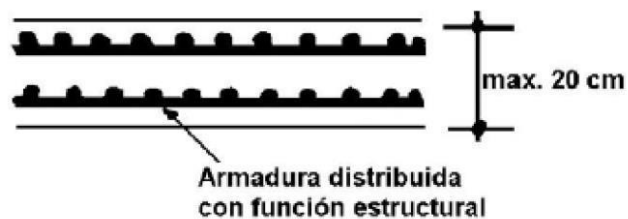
Pavimento de concreto con refuerzo. Fuente ASOCEM (2016)
